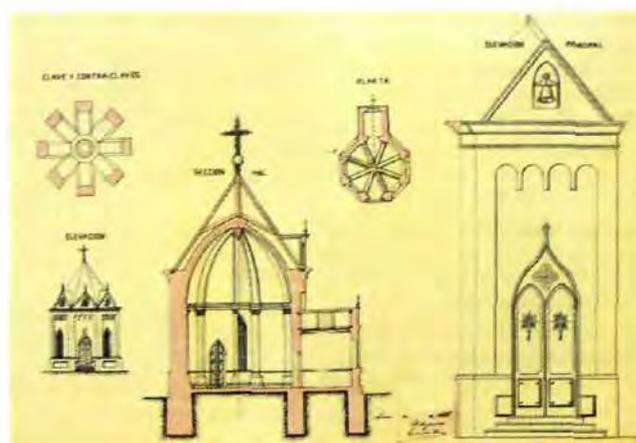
Planta, sección y alzado de la capilla. Ingeniero Riera. 1888
